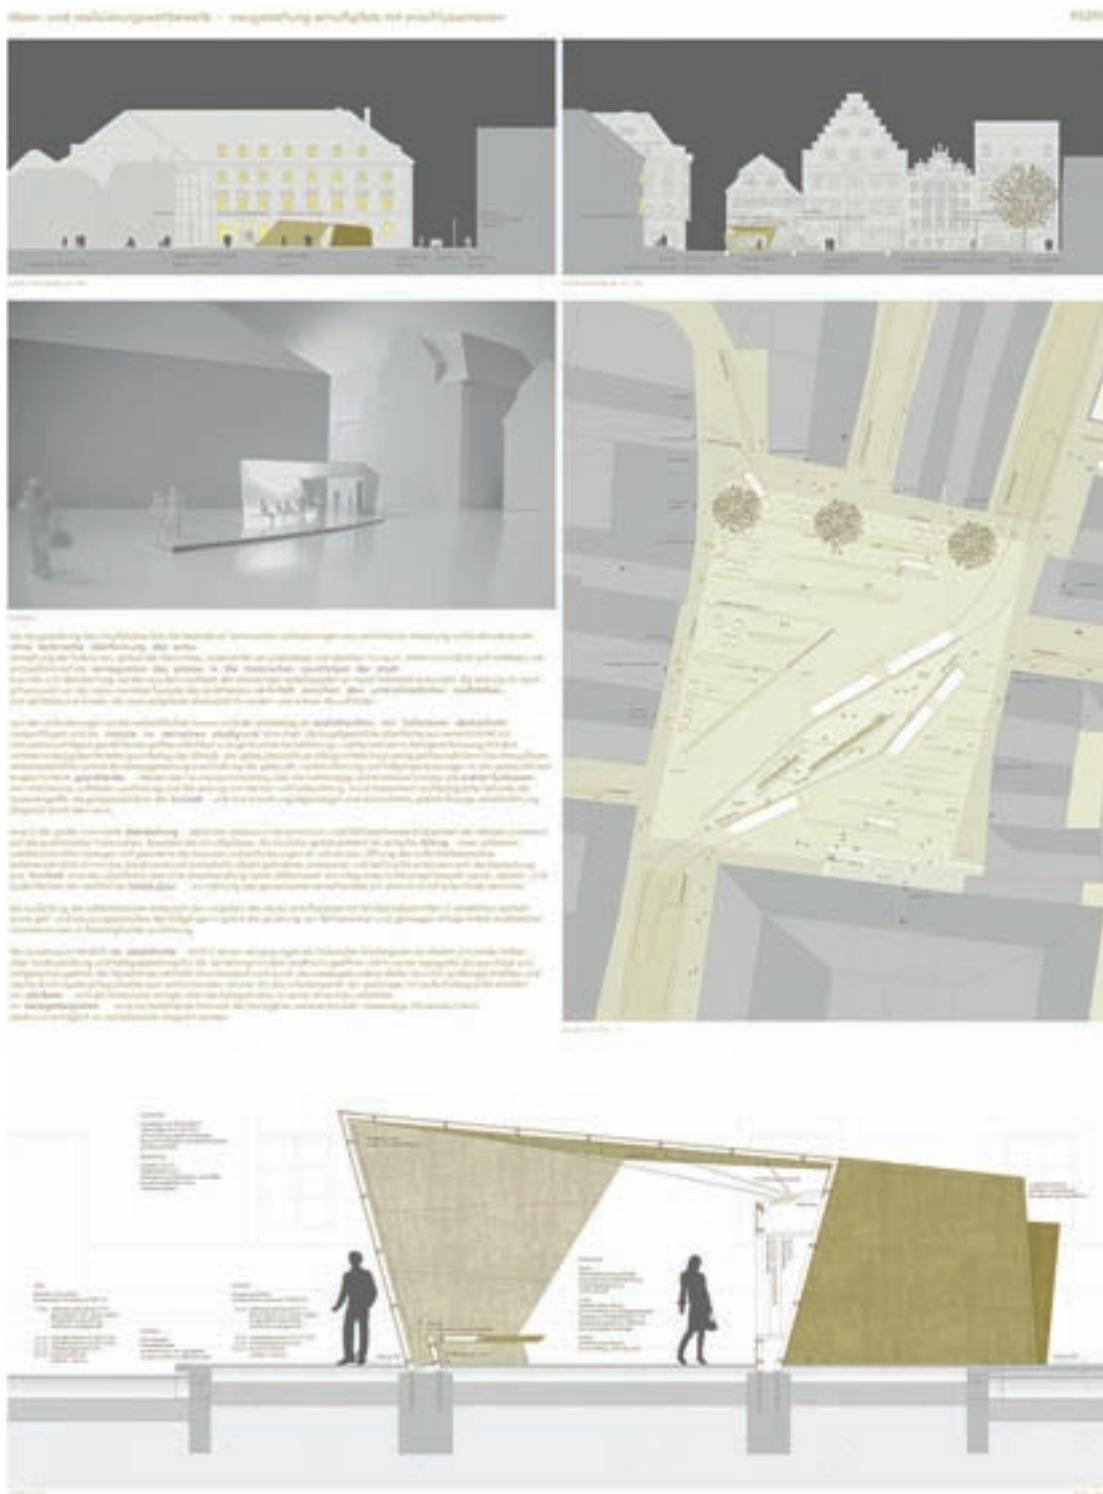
Wettbewerbsergebnis des ersten Preisträgers: Ansichten, Modell, Grundriss Realisierungsbereich, Schnitt Haltestellenüberdachung
